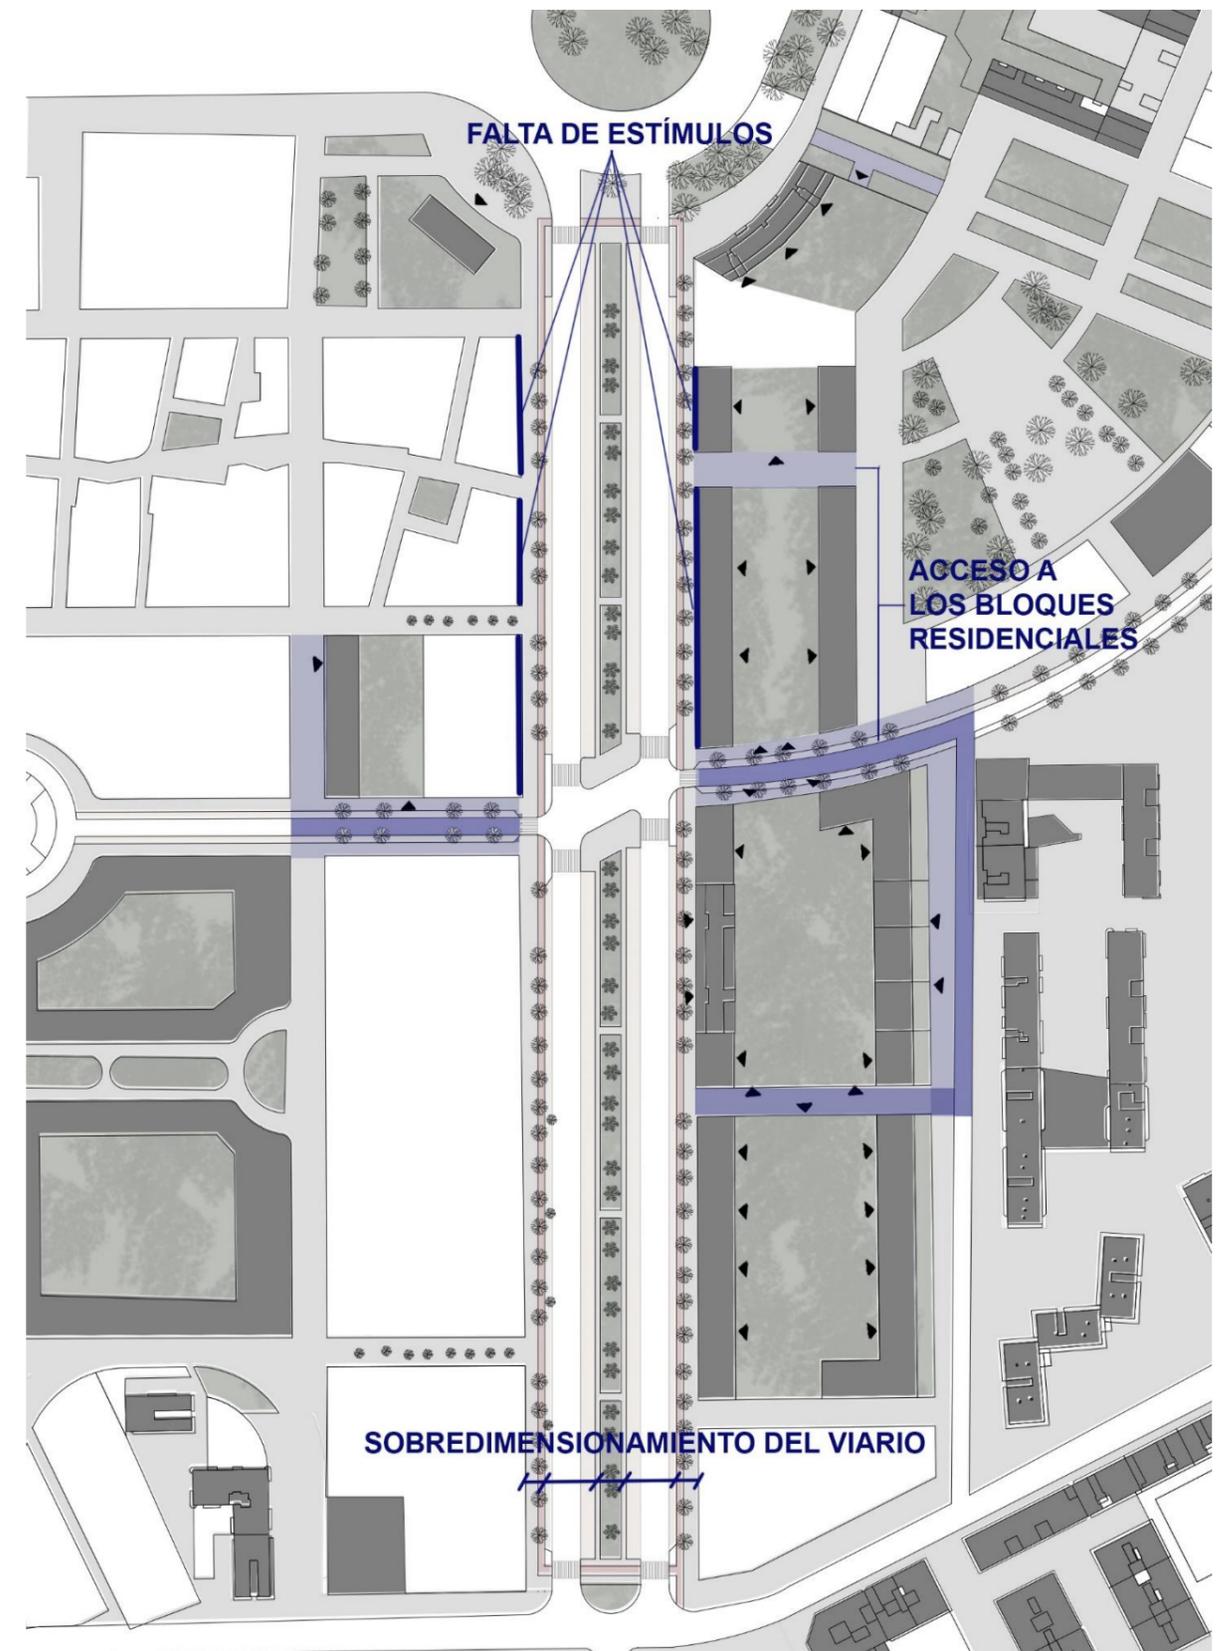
Plano Av. Levante U.D., elaboración propia
